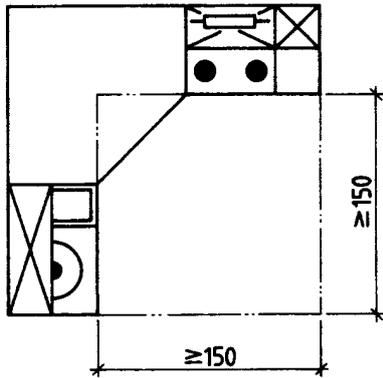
Bewegungsfläche in einer überdeck angeordneten Küche
